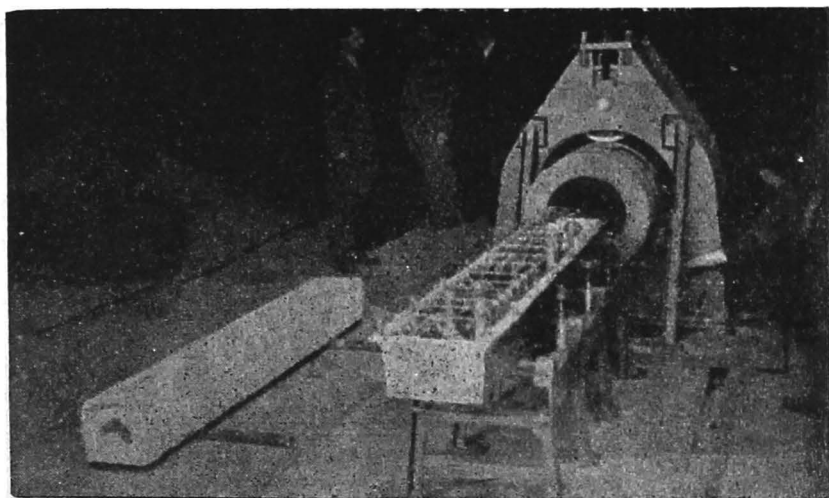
O altă poziție a mașinei; în stânga se vede traversa de beton armat.
